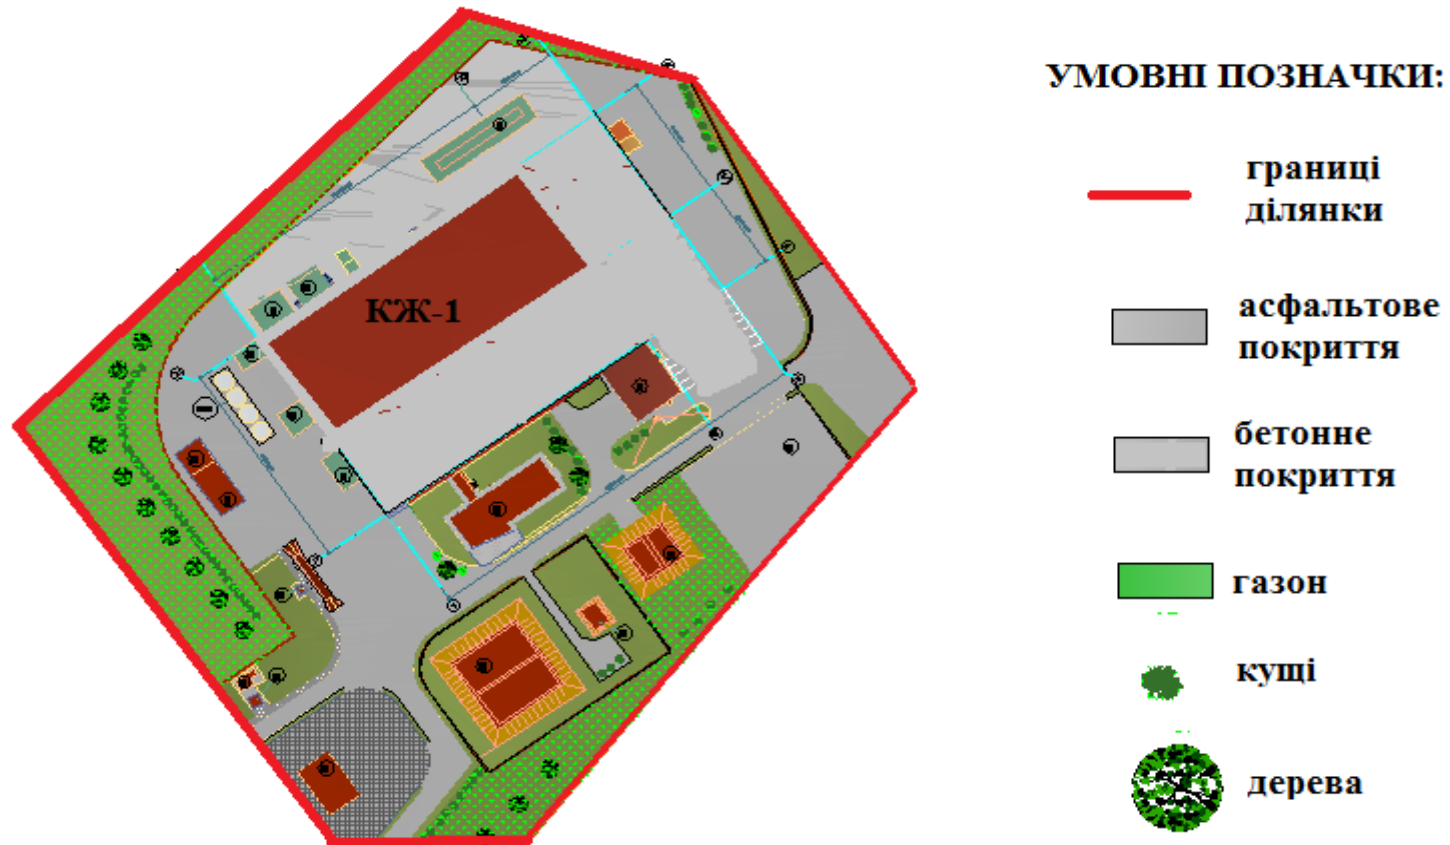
План будівельного майданчика (фрагмент генплану)
